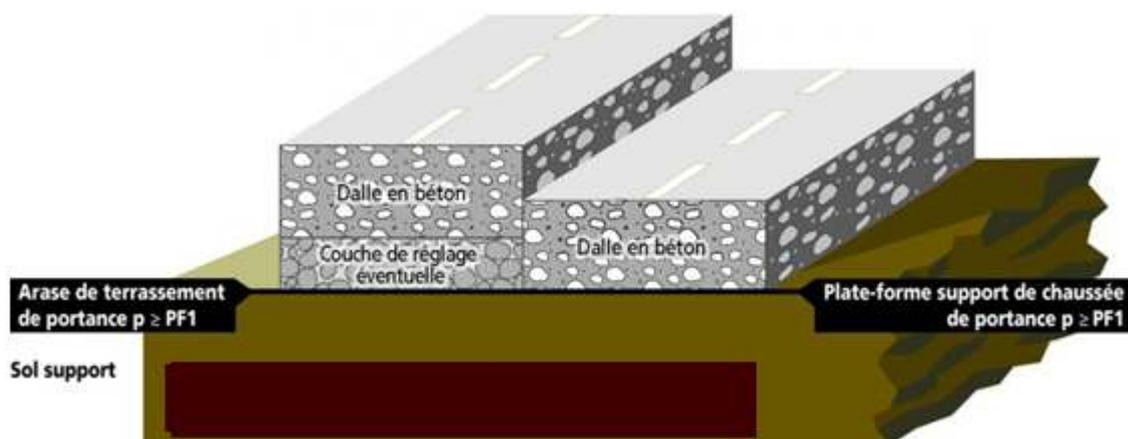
Structure type d'une chaussée à trafic < ou égale 50 PL/j/sens
